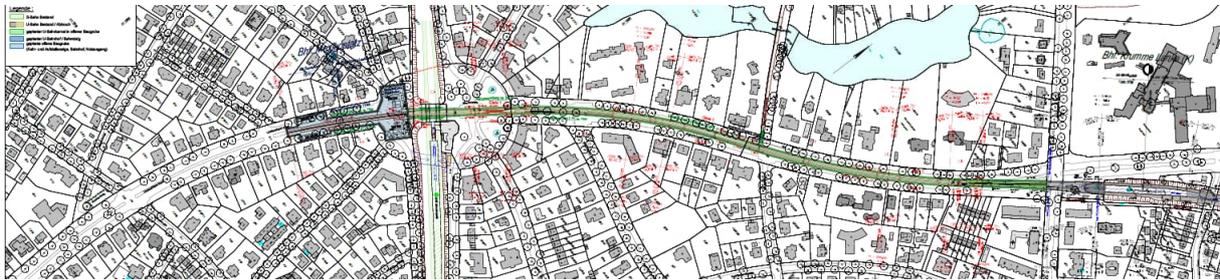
Grundrissübersicht Variante V1.2
